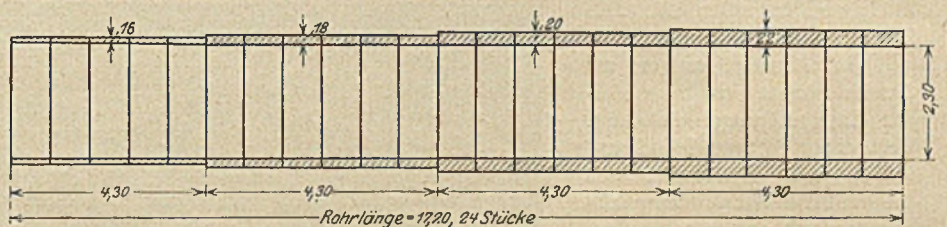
Druckrohr fürs Kraftwerk Föhrenwald.
